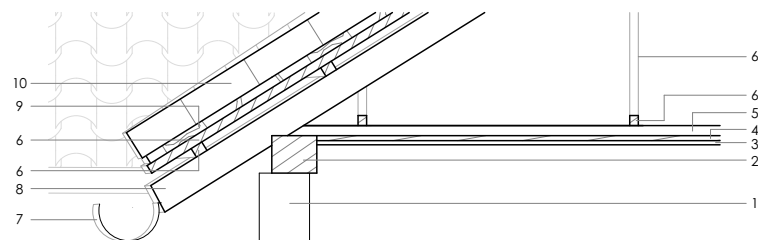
Detalle Constructivo 01. ESC 1:50
